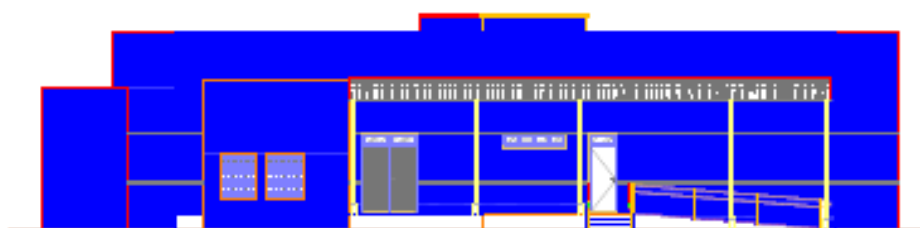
Fachada posterior (LESTE). (Acervo UFRSA Caraúbas)
